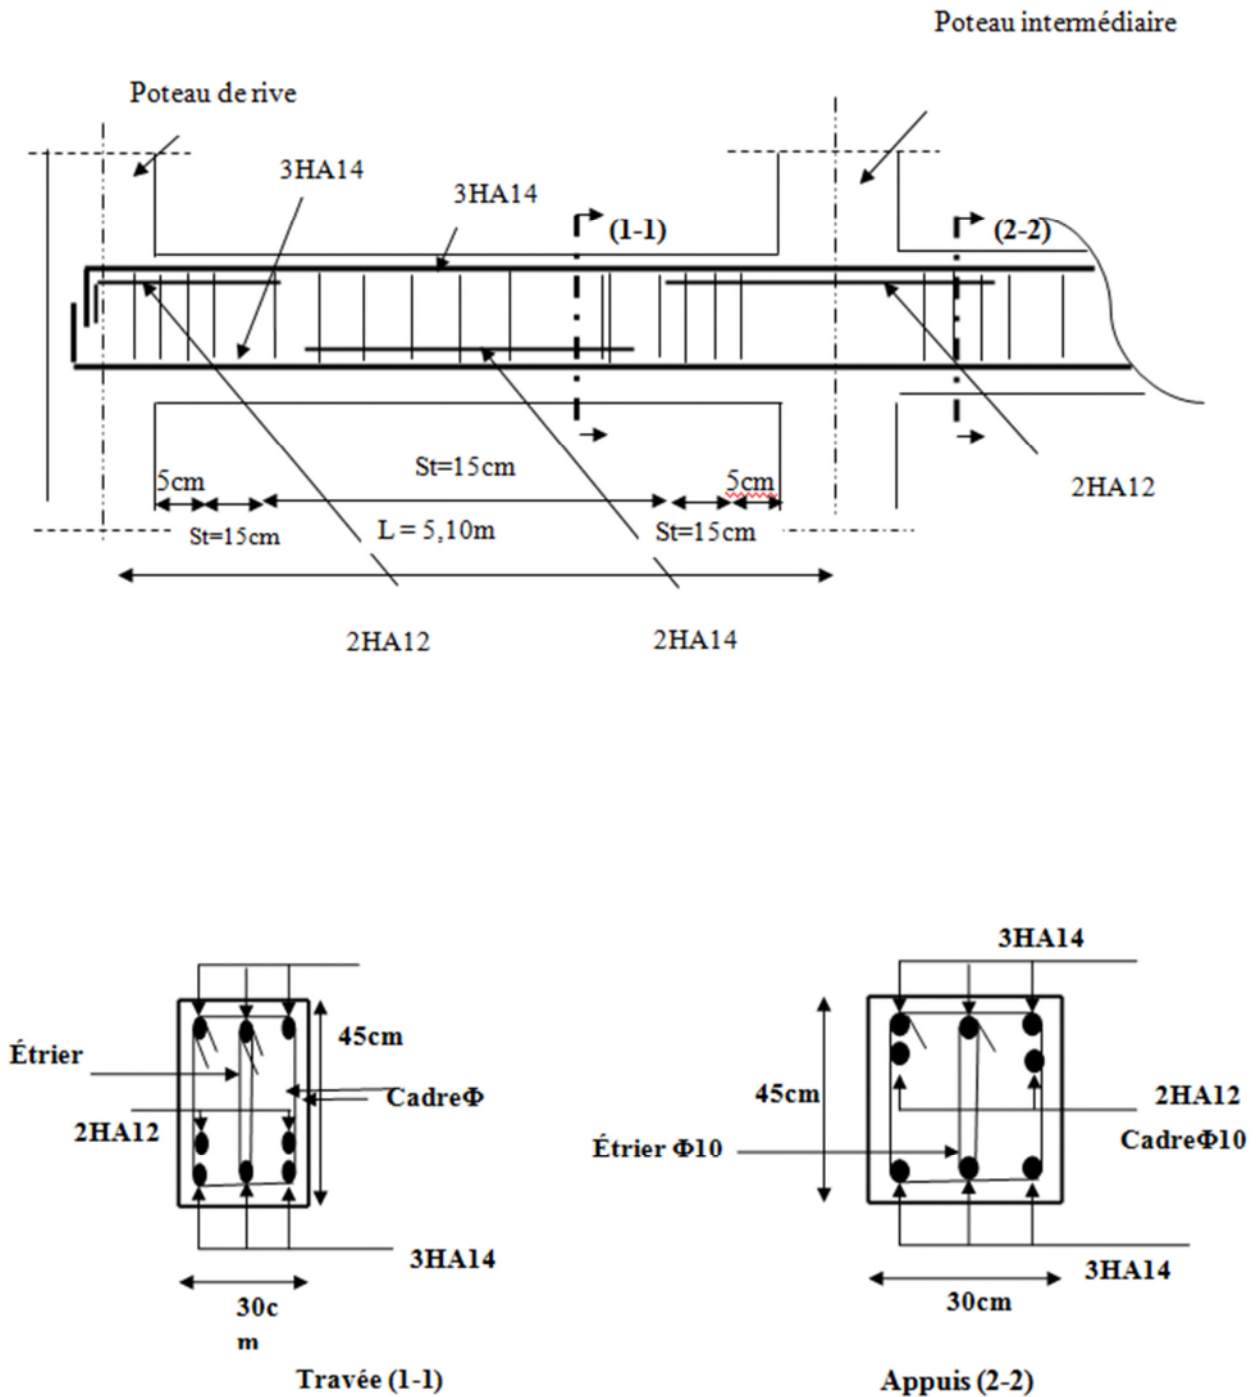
Schéma de ferrailage de la poutre principale (30*45) pour tous les niveaux (du sous sol au 9^{ème} étage + terrasse inaccessible)
